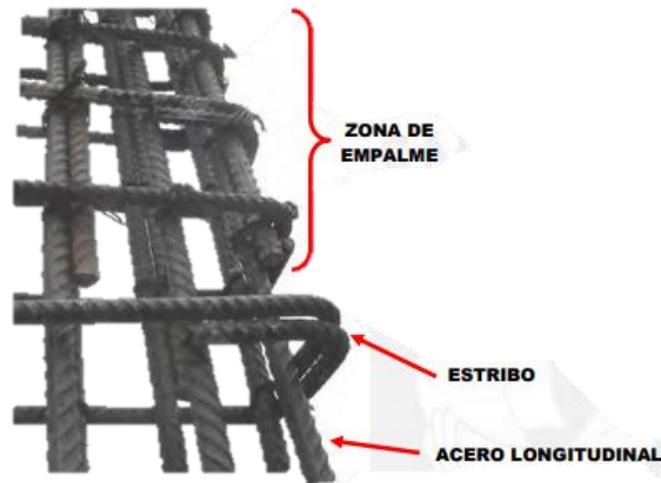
acero longitudinal fuera de la esquina del estribo debidos a los empalmes verticales. Situación muy común cuando se utilizan barras de acero de diámetro elevado.
